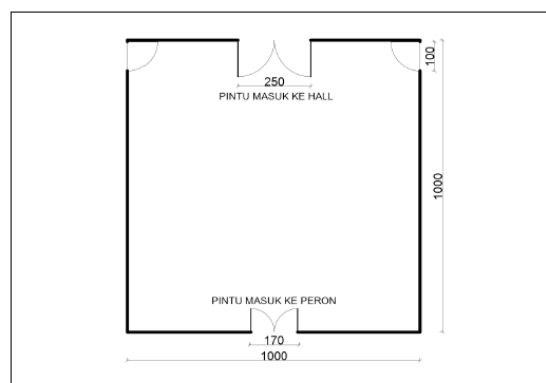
17 Tipikal Denah Ruang Serba Guna
